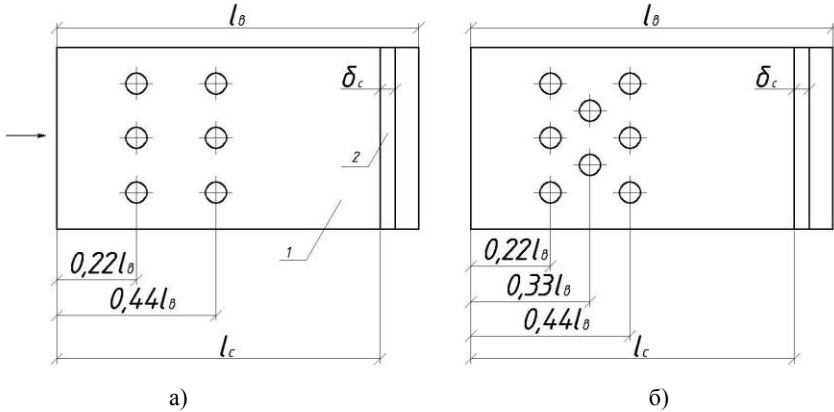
Схема раціонального розташування дренажних отворів при наявності на водобой суцільної водобійної стінки а) при двохранному розміщенні колодязів; б) при трьоххранному розміщенні колодязів
